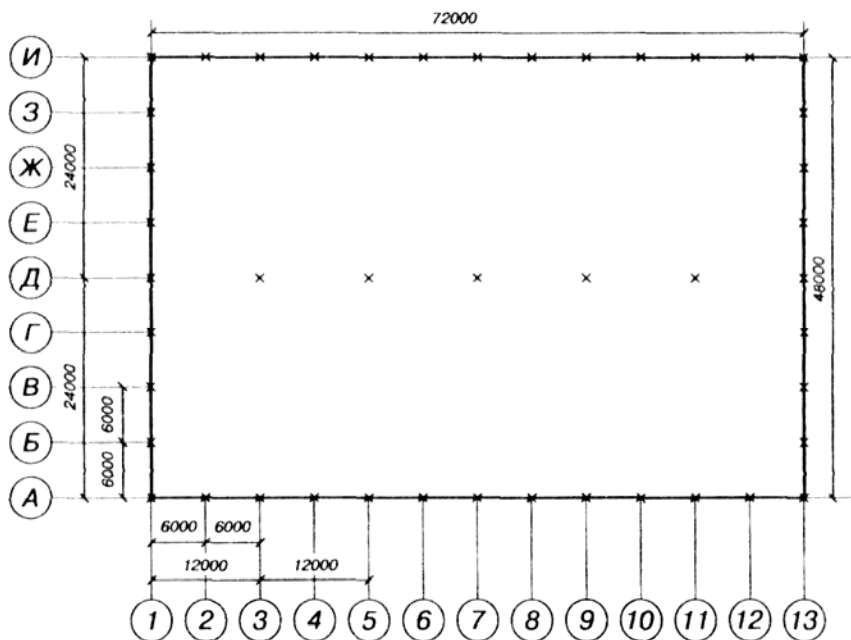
Нанесение размеров и координатной сетки на чертеже планировки производственного корпуса
